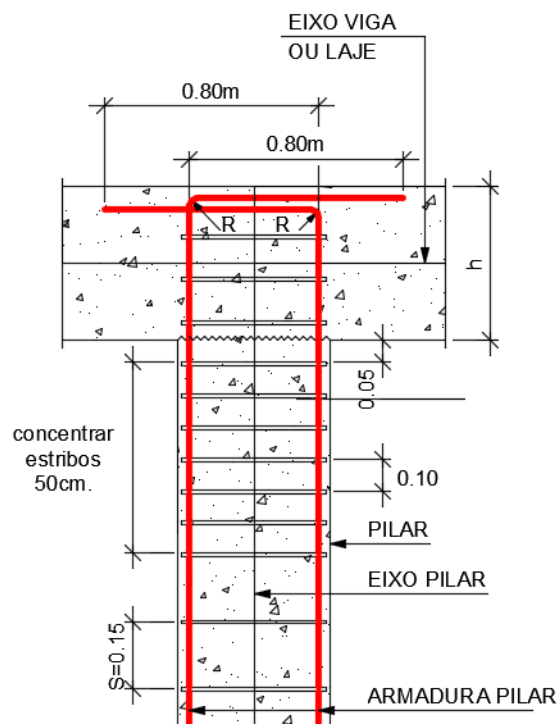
Pormenor da armadura nos pilares (Fonte: Projeto de Estrutura)
